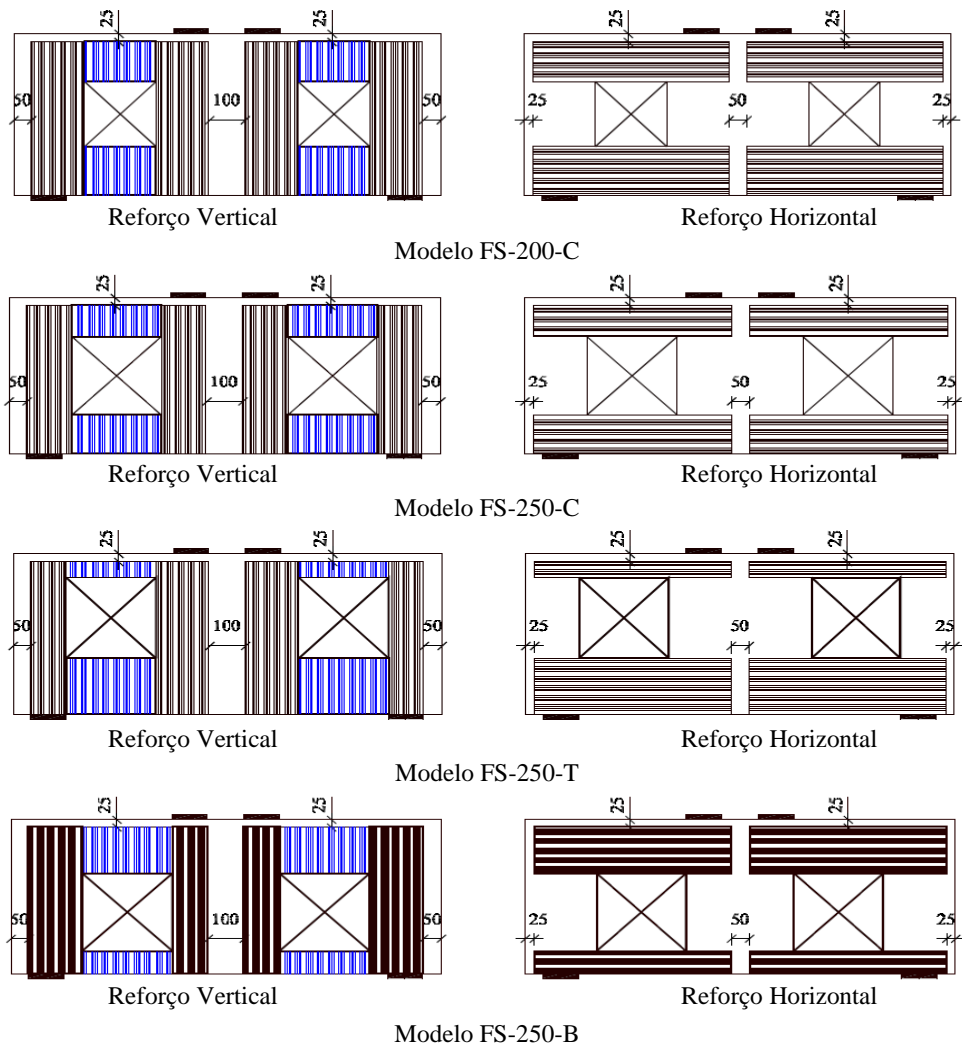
Configuração reforço (dimensões mm) (El-Maaddawy e Sherif, 2009)
